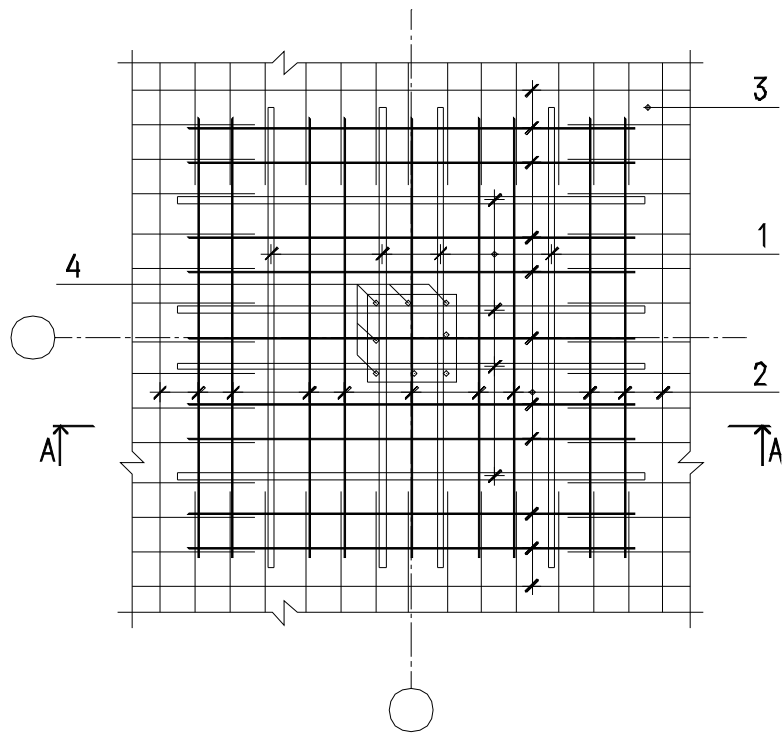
Фрагмент сплошной монолитной железобетонной фундаментной плиты с устройством скрытой металлической капители: 1 – стальные листы; 2 – арматура периодического профиля; 3 – бетон; 4 – арматура колонны.
